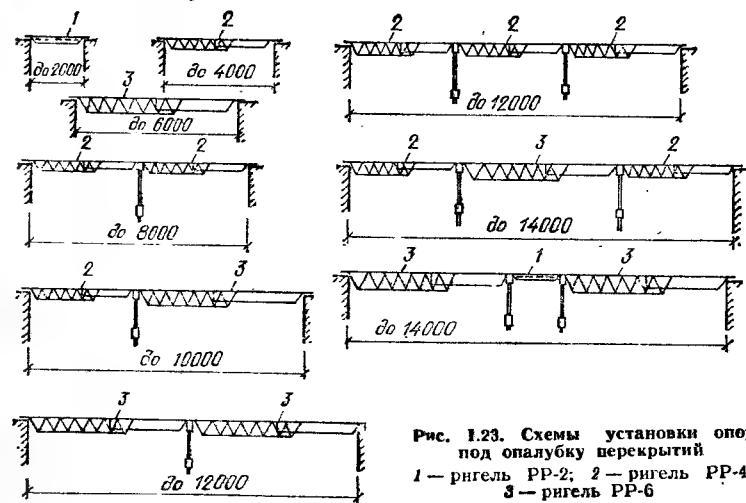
Схемы установки опор под опалубку перекрытий
